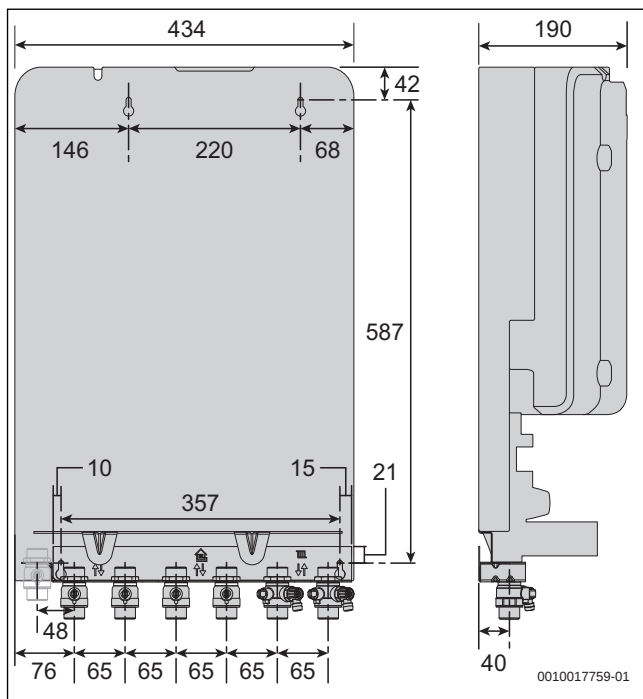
Abmessungen Wohnungsstation zur Unterputz-installation (Maße in mm)
